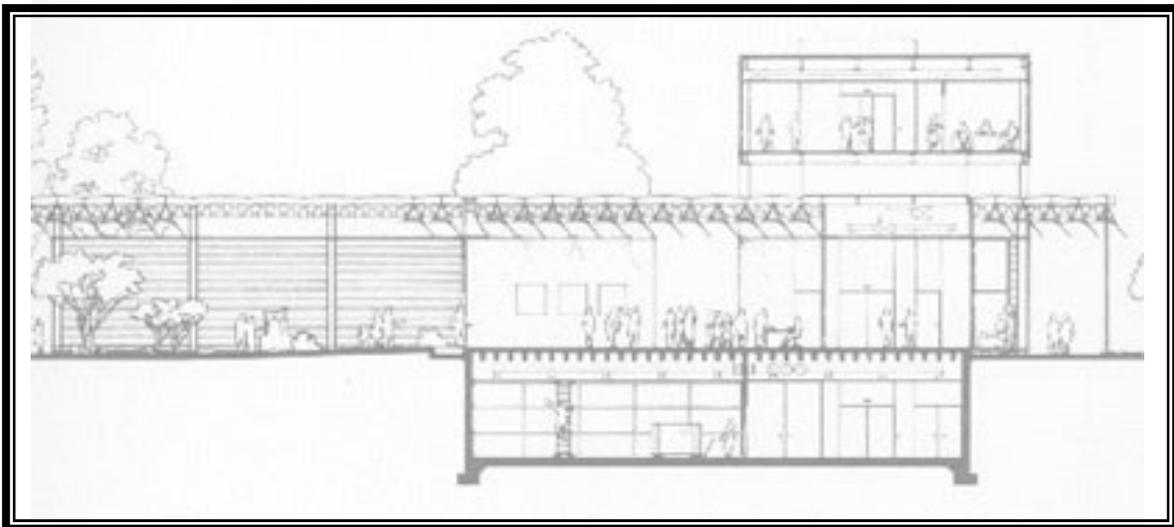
Iluminación cenital vista en corte longitudinal Museo Menil Collection de Renzo Piano.
